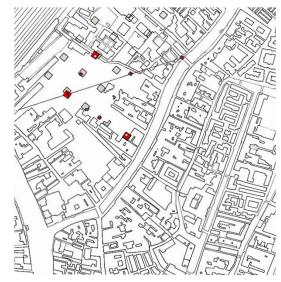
Fotografía del proyecto para la plaza del Cannareaio
